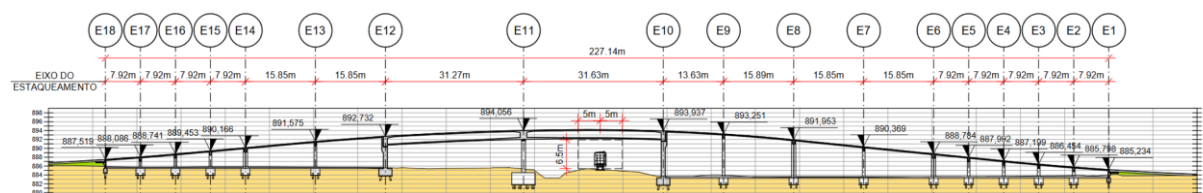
ELEVÇÃO LONGITUDINAL - RAMO 400
